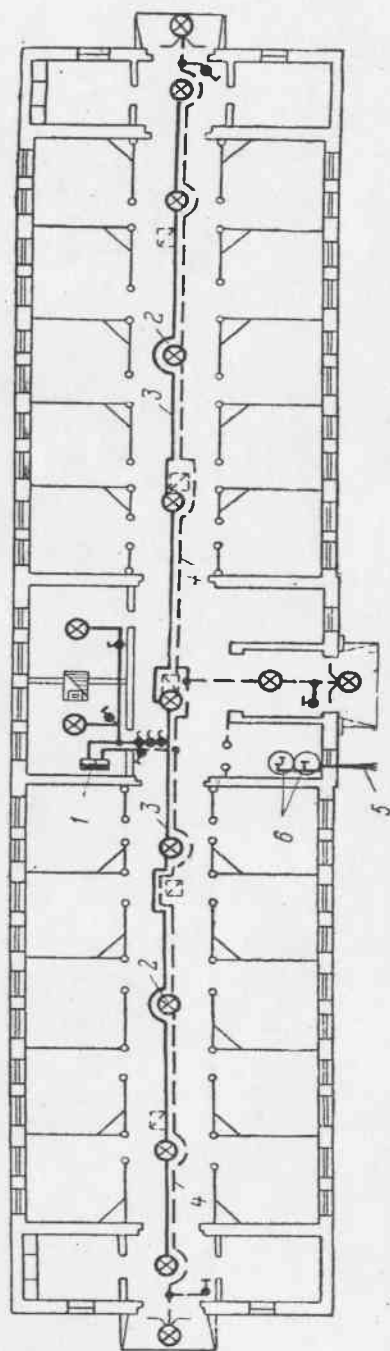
План конюшни на 20 племенных лошадей со схемой сетей электроосвещения и водопровода: 1—групповой щиток; 2—арматура фарфоровая полугерметическая; 3—сеть рабочего освещения; 4—сеть дежурного освещения; 5—ввод от наружного водопровода; 6—бочки для воды.
